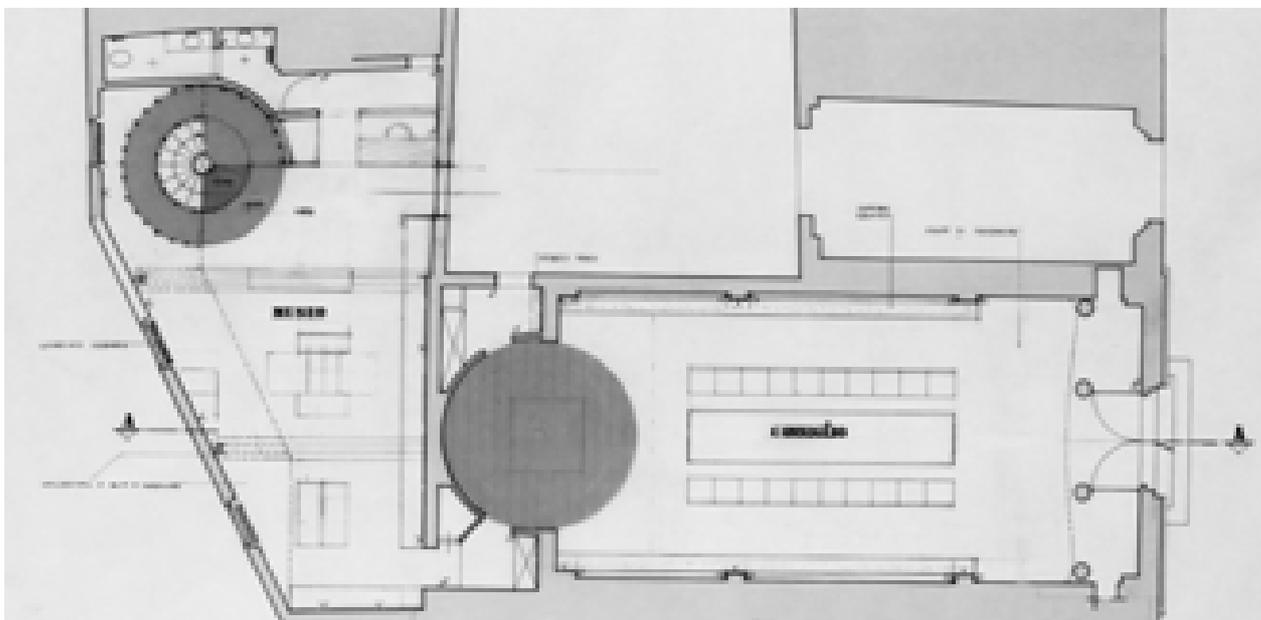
Pianta quota +0,00 – Stato di progetto – 10/11/1980 (AABS-94.167)
